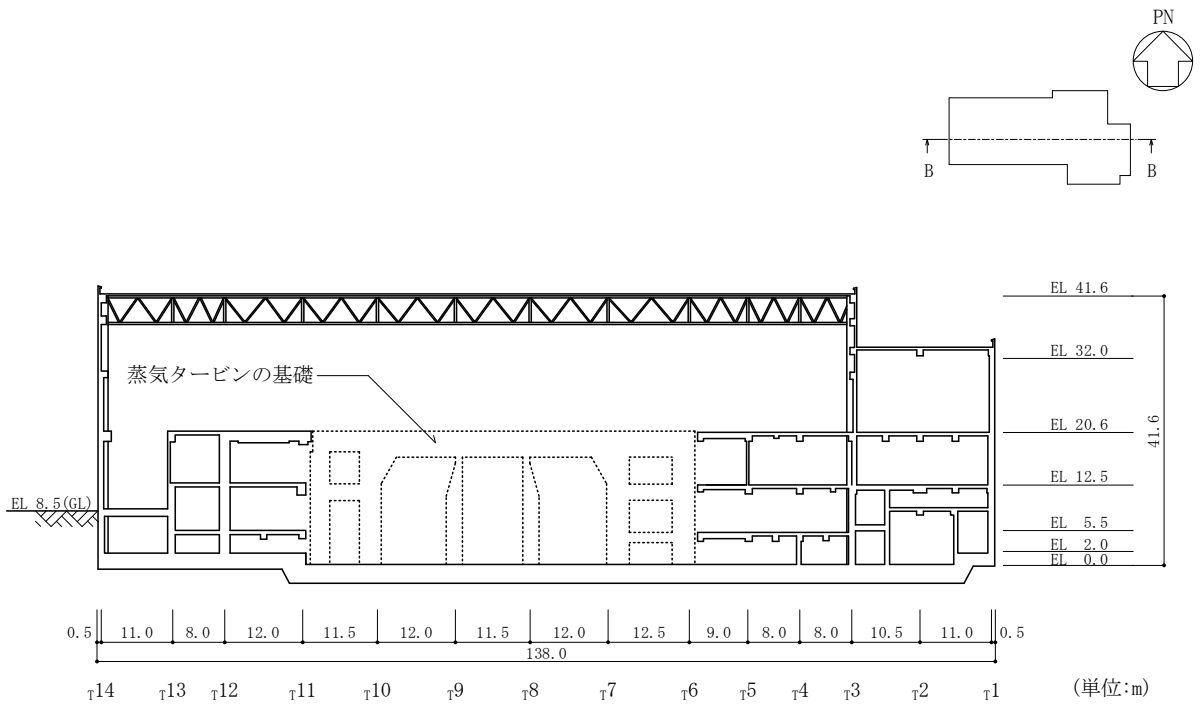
(2) タービン建物の概略断面図 (B-B断面, EW方向)
